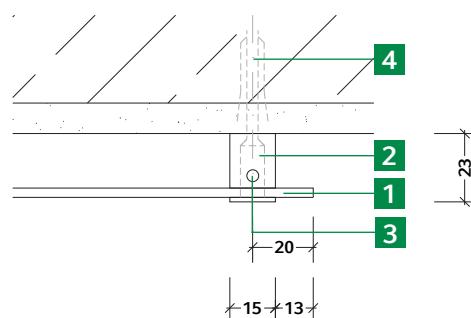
Gebäudekennzeichnung - Gebäudename Detail 01
